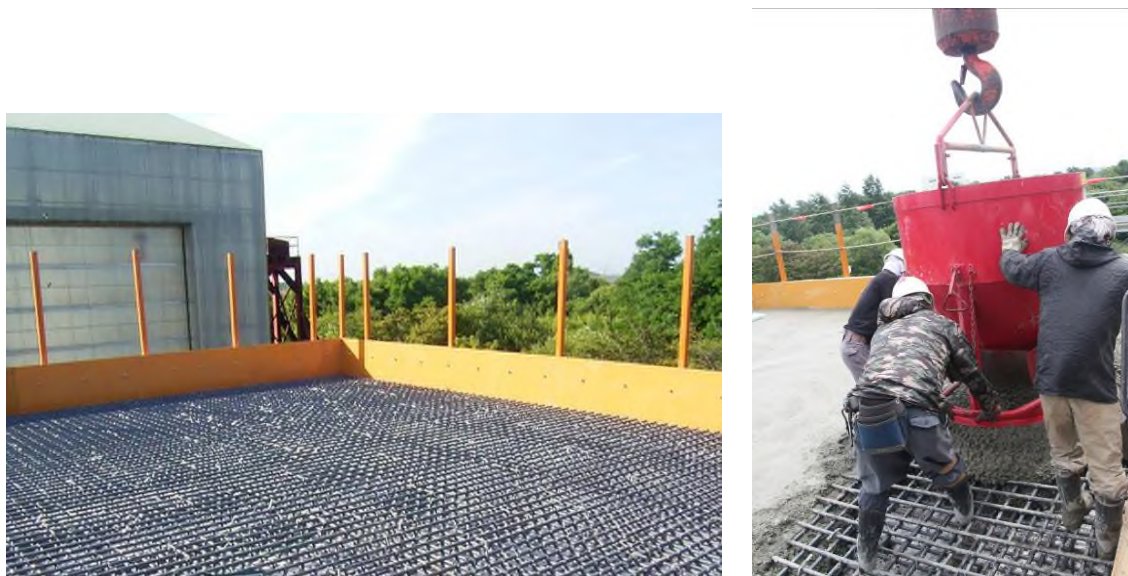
TLAS の配筋状況とコンクリート打設状況
